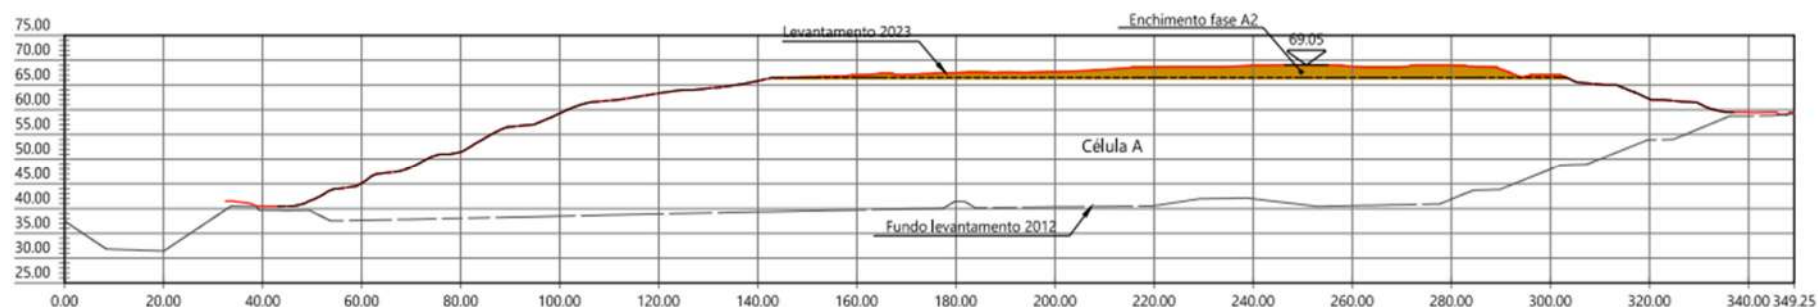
Perfil de enchimento da Fase A2 sobre a Fase A
